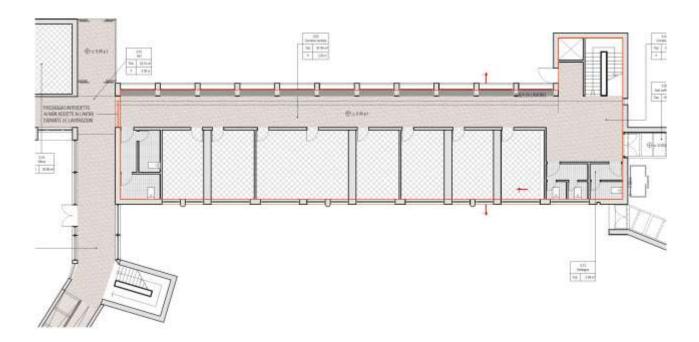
Particolare area di cantiere lotto 2 - piano terra
